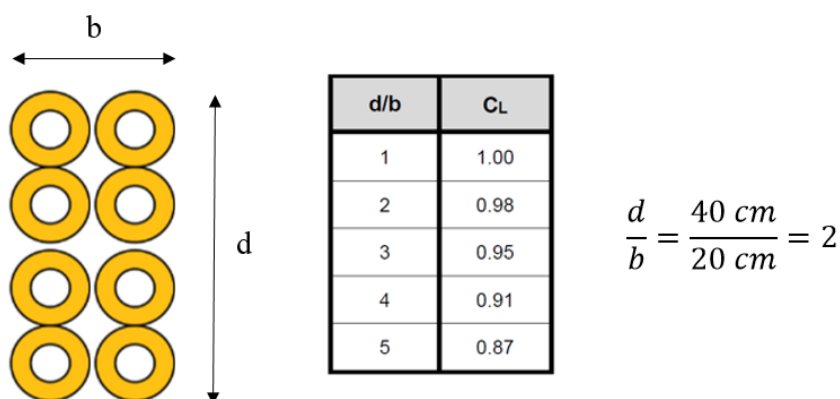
Sección compuesta de GaK considerada para determinar C_L en vigas.
